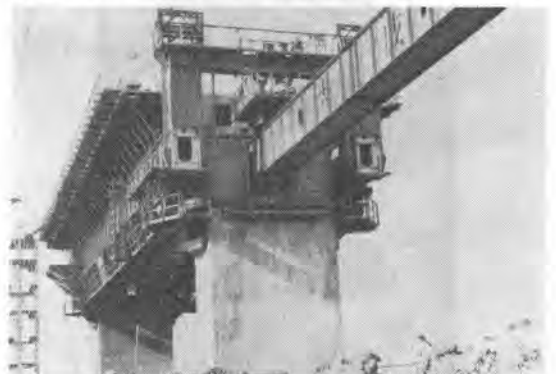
可動支保工による新幹線北上川橋梁の施工状況
